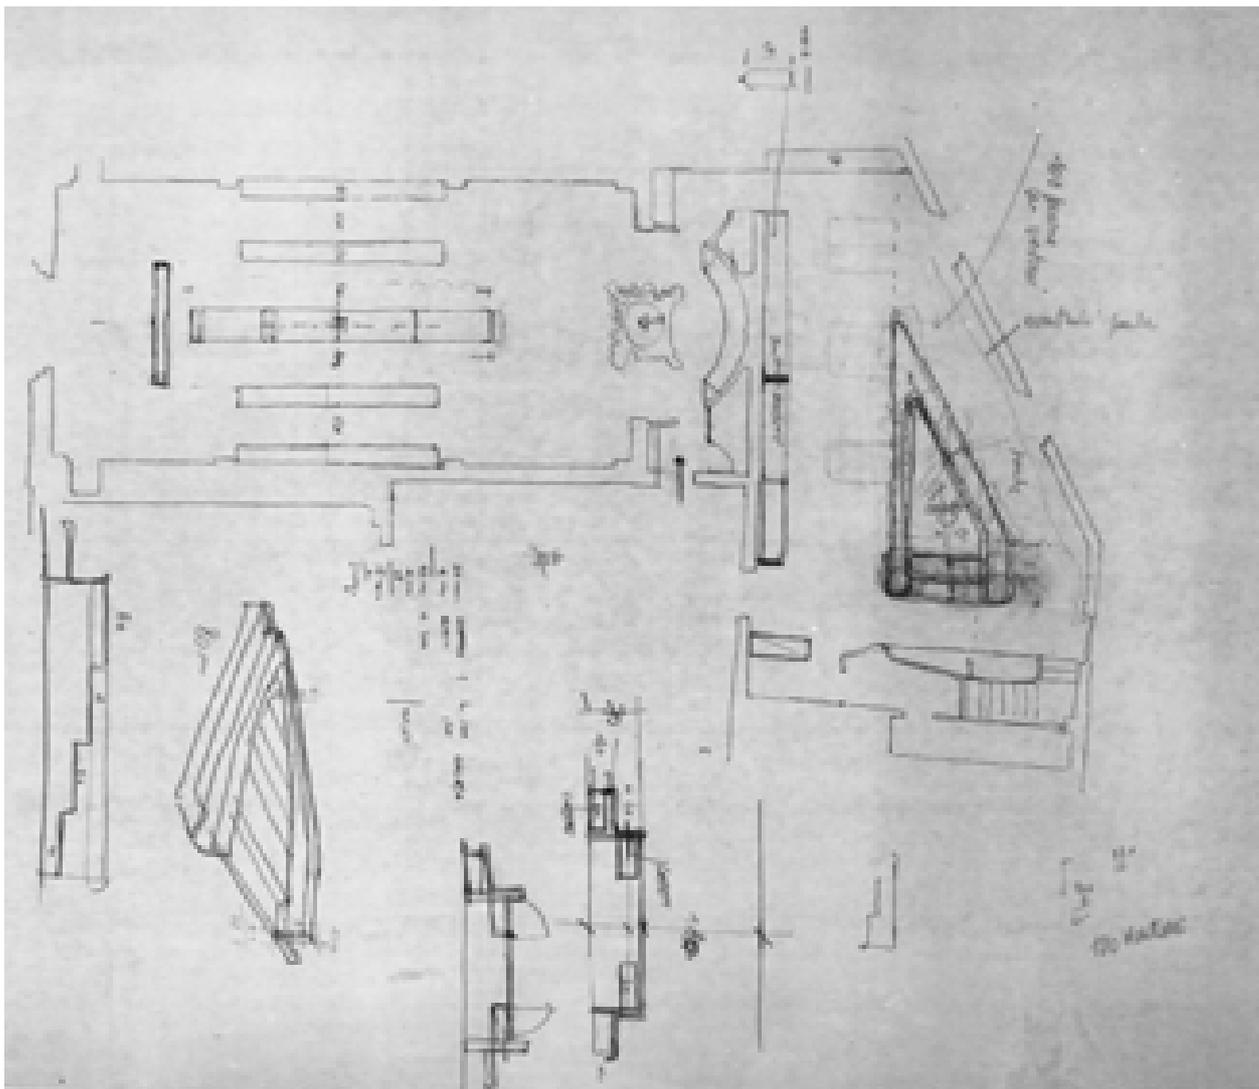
San Leonardo, sistemazione piano terra – s.d. (AABS-94.137)
